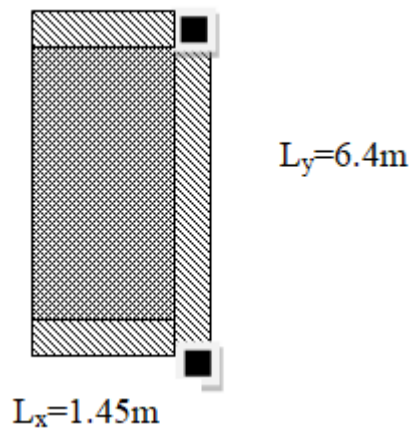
Schéma de la dalle pleine reposant sur trois appuis (D1).
